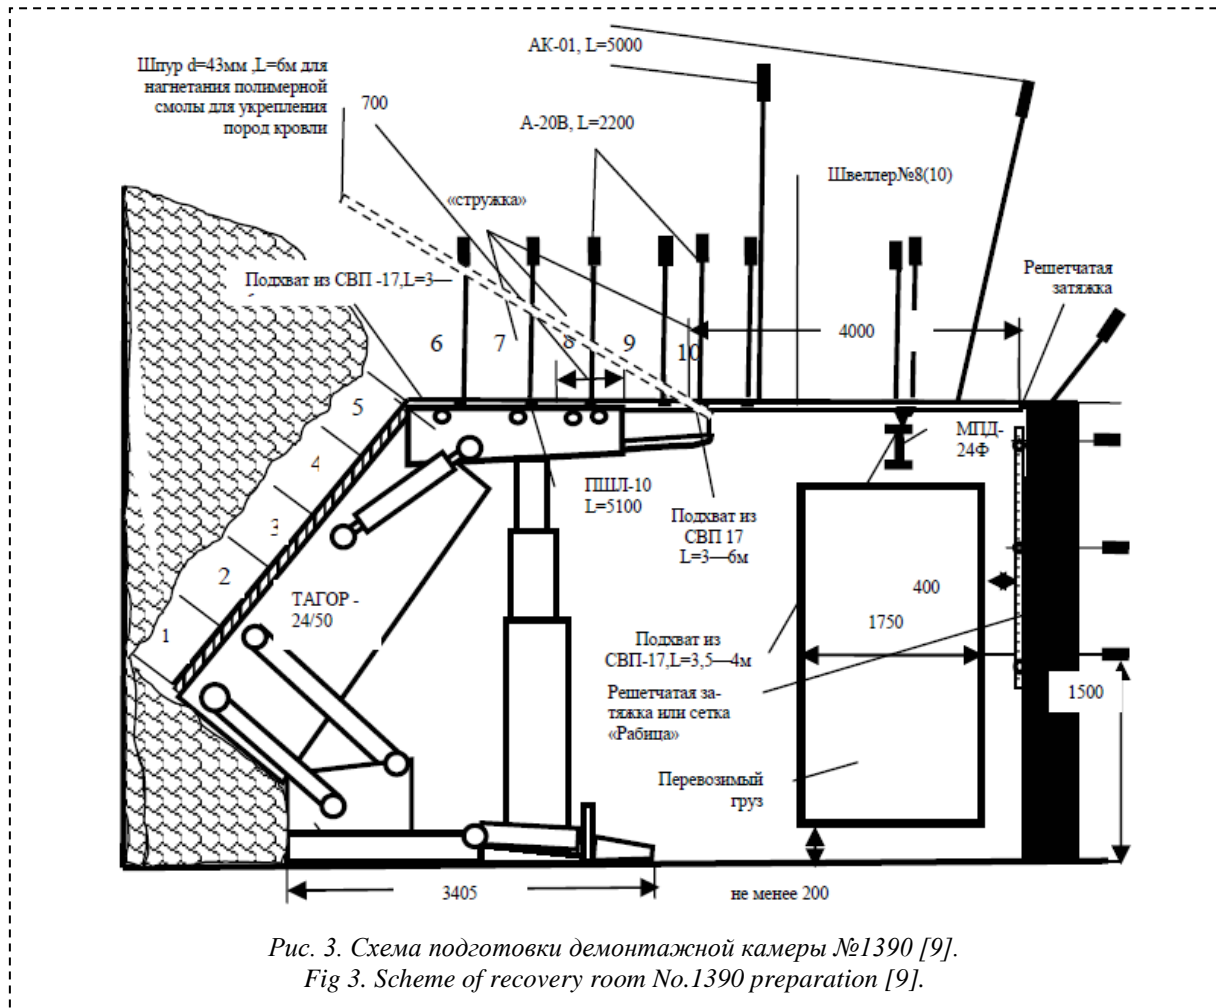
Схема подготовки демонтажной камеры №1390 [9].
